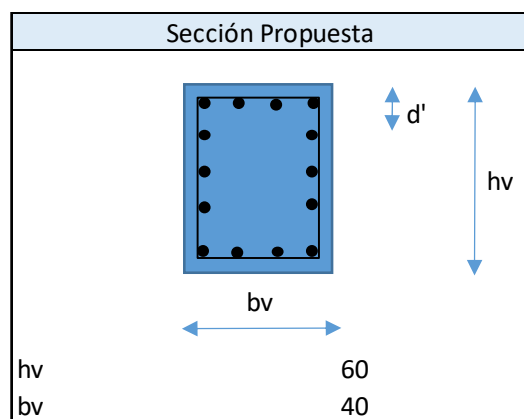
Vigas de cimentación medianeras ejes B1 y B4
